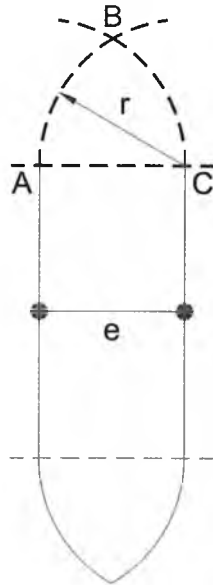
Construcción geométrica de la planta de un tajamar, según Belidor (1750).
